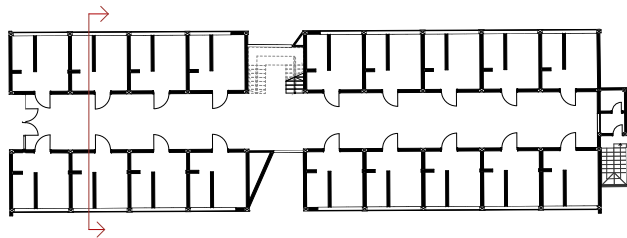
Planta de referencia. Fuente: Autoría propia.
